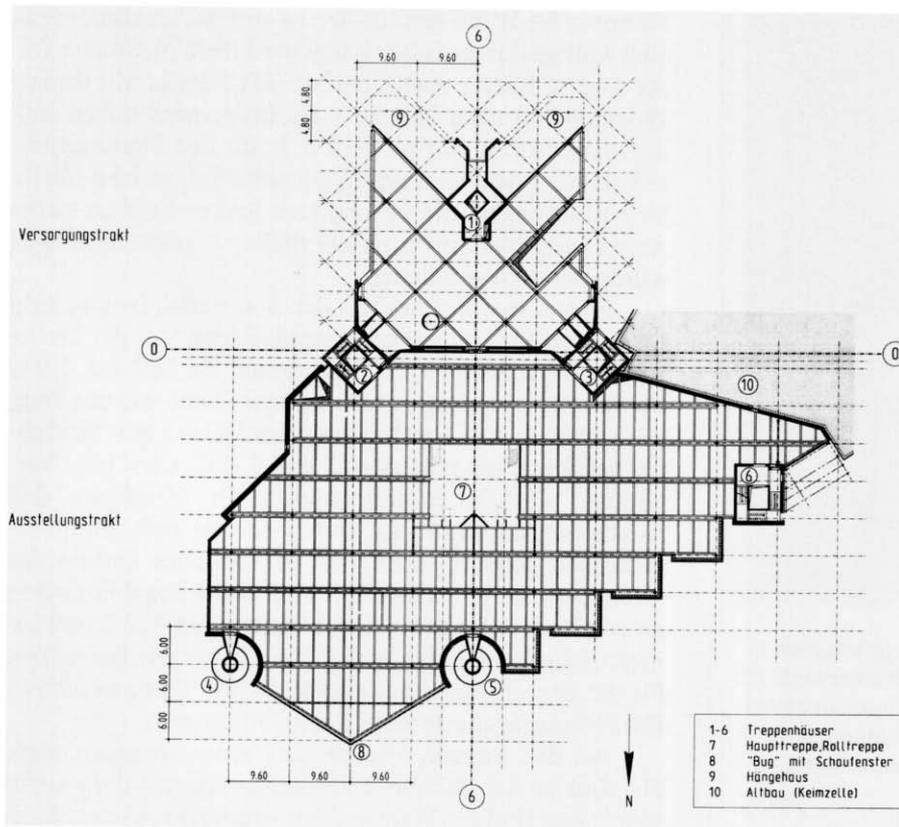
Grundriß des Neubaus für Luftfahrt und Schifffahrt mit Gebäuderaster
